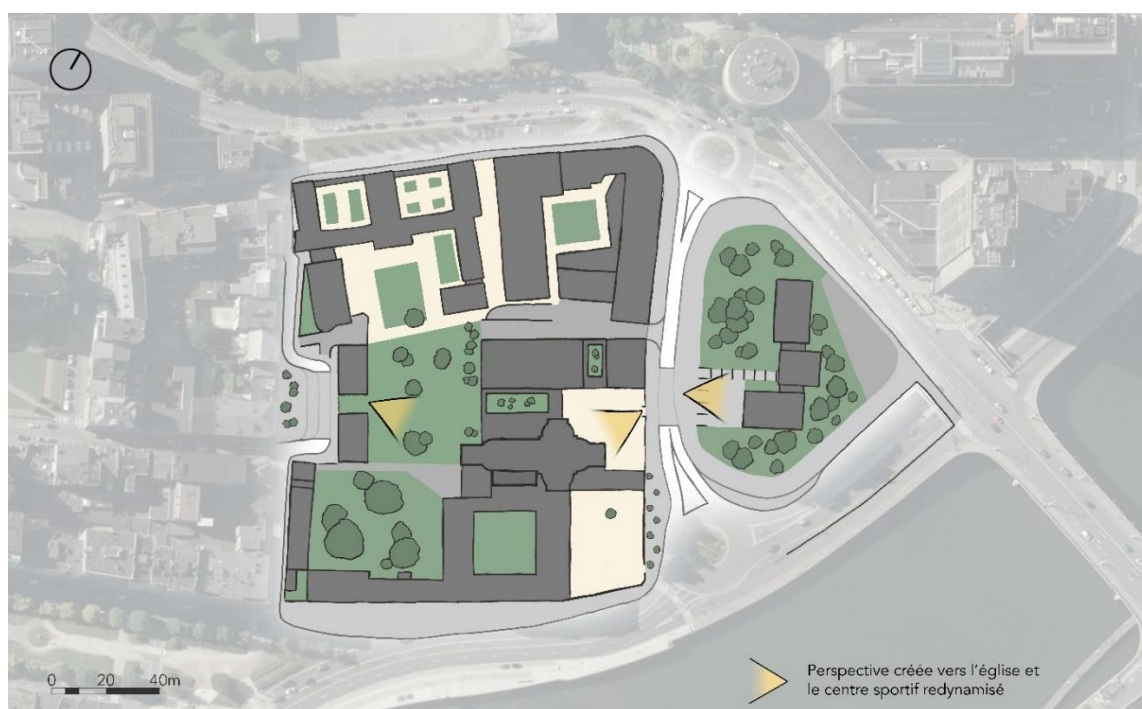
Nouvelles perspectives possibles vers l'église et le centre sportif redynamisé (fond de plan WalOnMap, 2016)
